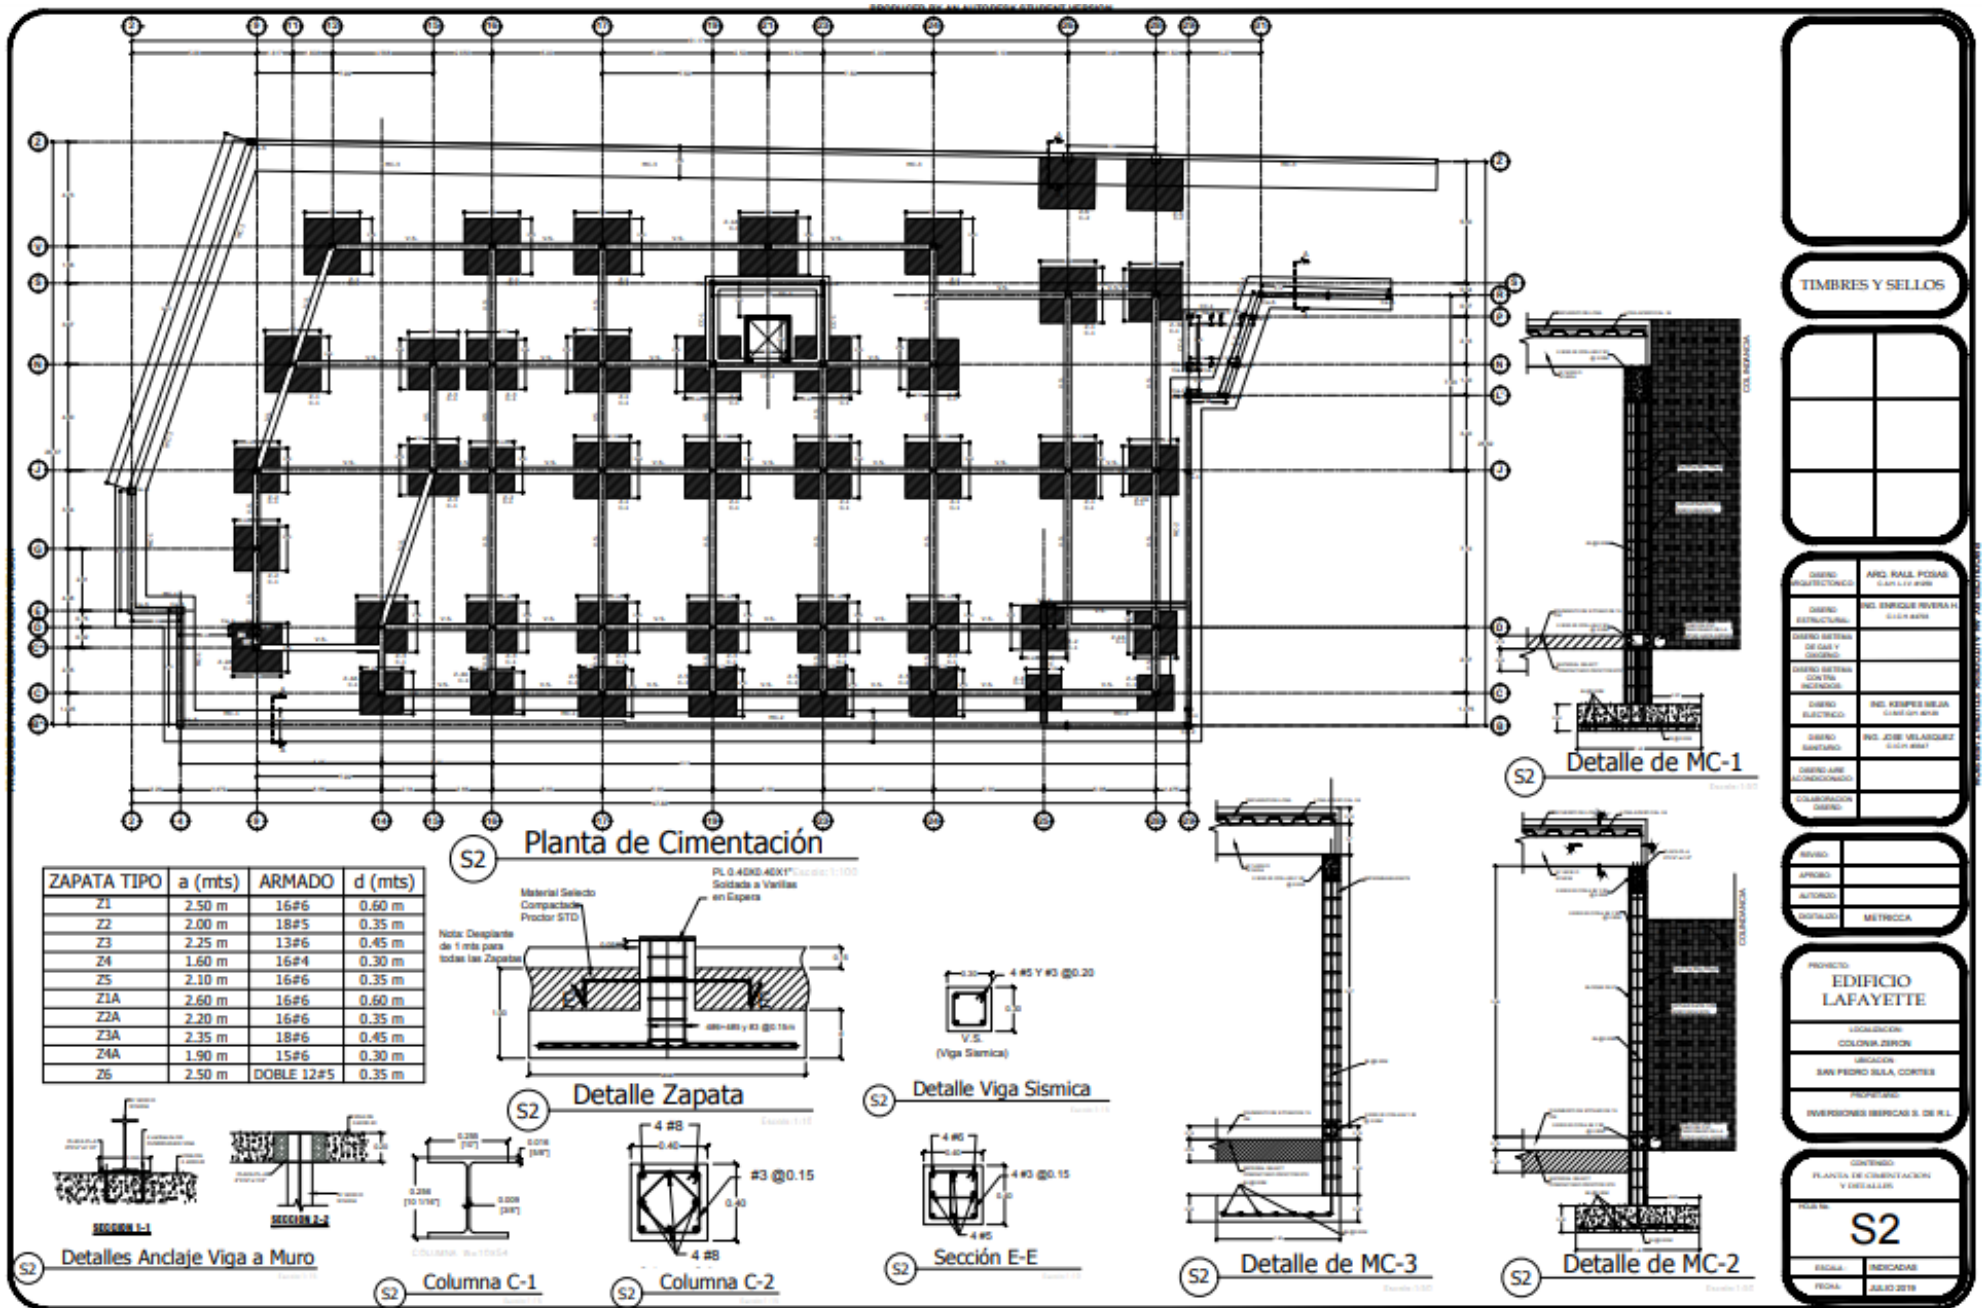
Plano de cimentación de edificio LAFAYETTE.
